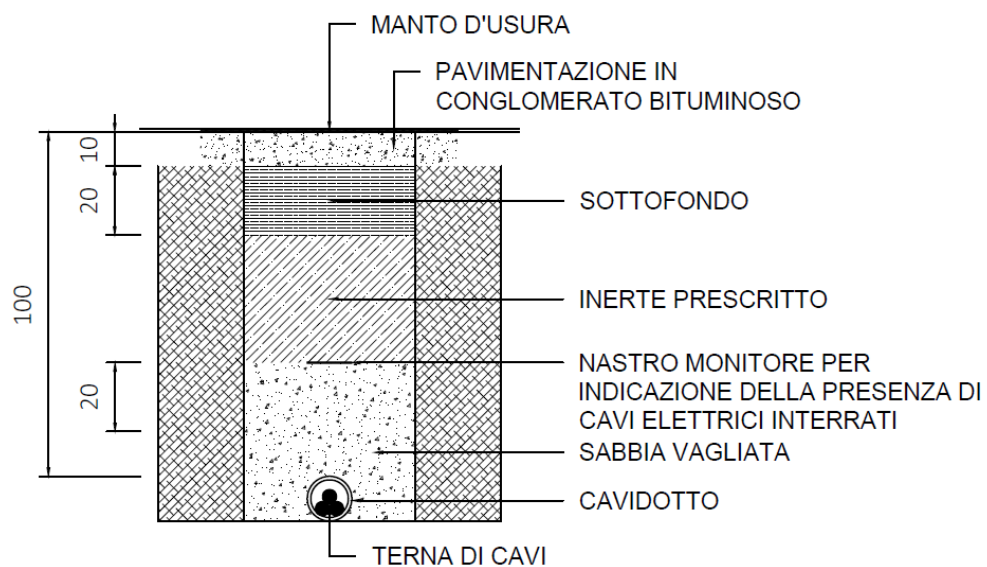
Sezione tipo scavo posa cavidotto su strada asfaltata
